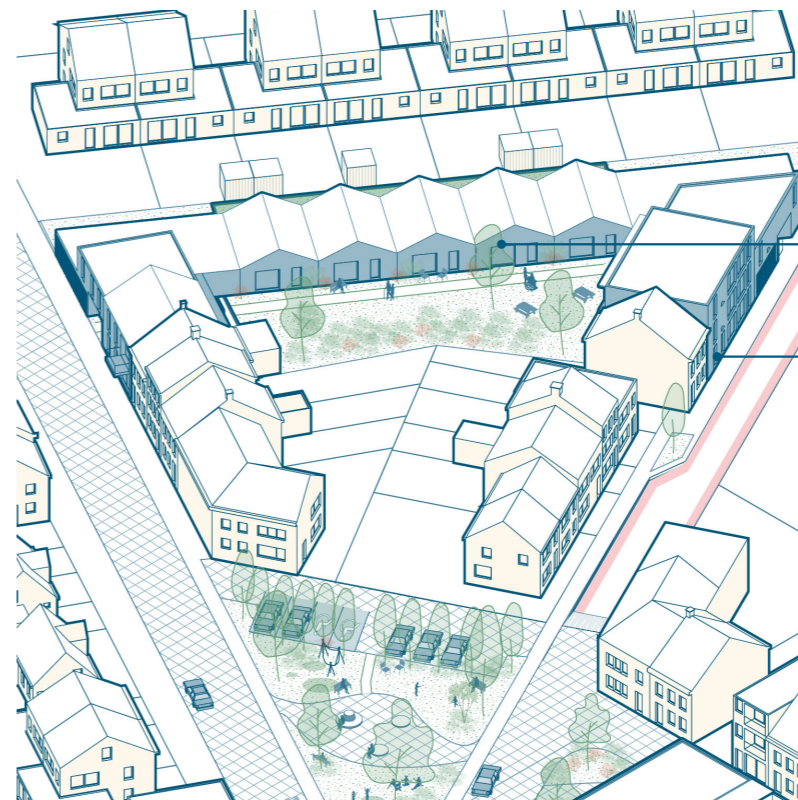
(Links) Schoolstraat Wijnegem ontworpen door Osar (2019). Hier wordt uitgegaan van de kracht van samenwonen. De bungalowwoningen richten zich rond een gemeenschappelijke tuin.
